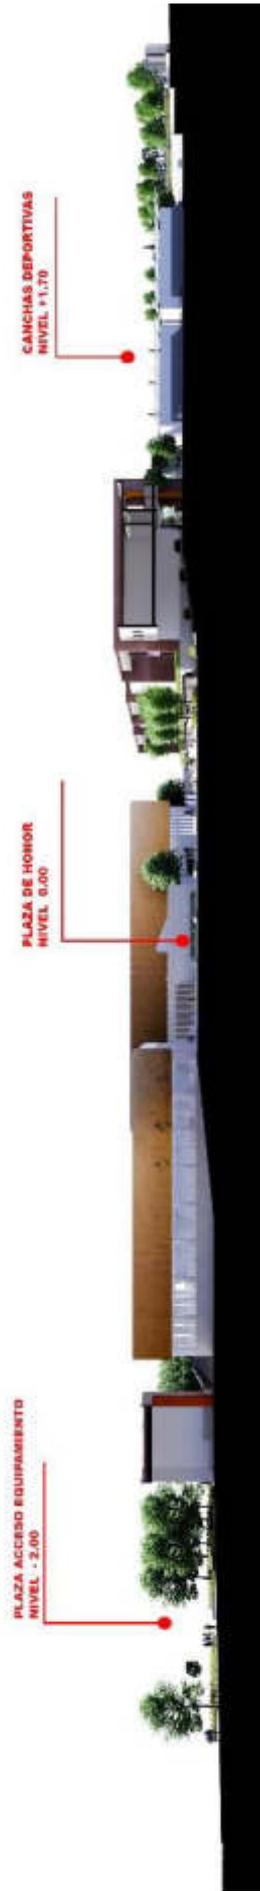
Sección 1-1 Norte-Sur de plan maestro. Elaboración: el autor
